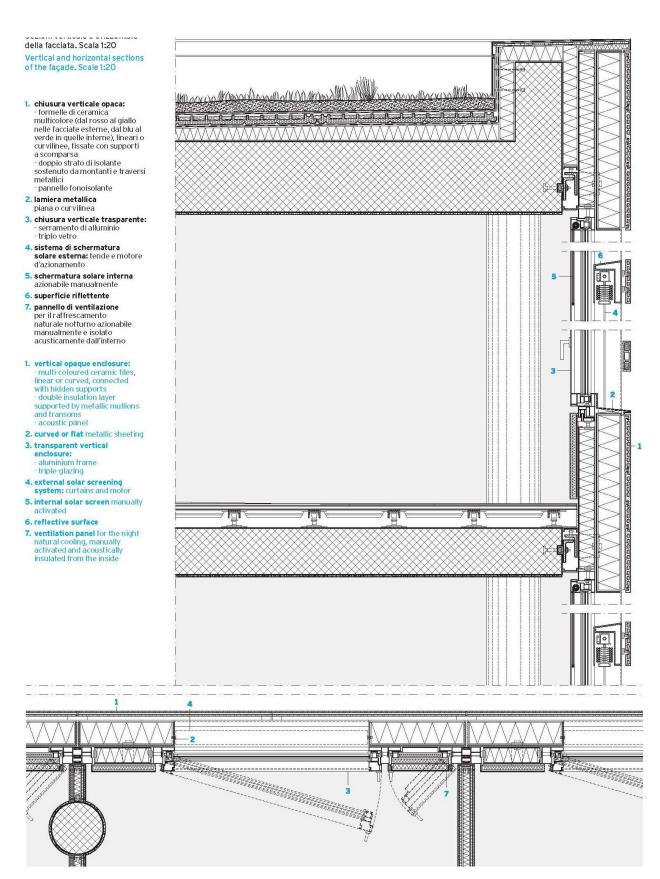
Sección vertical (arriba) y sección horizontal (abajo).
